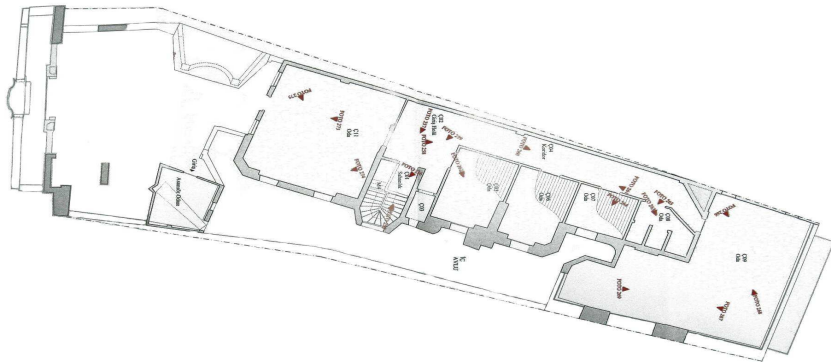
Botter Apartmanı Üçüncü Kat Planı
